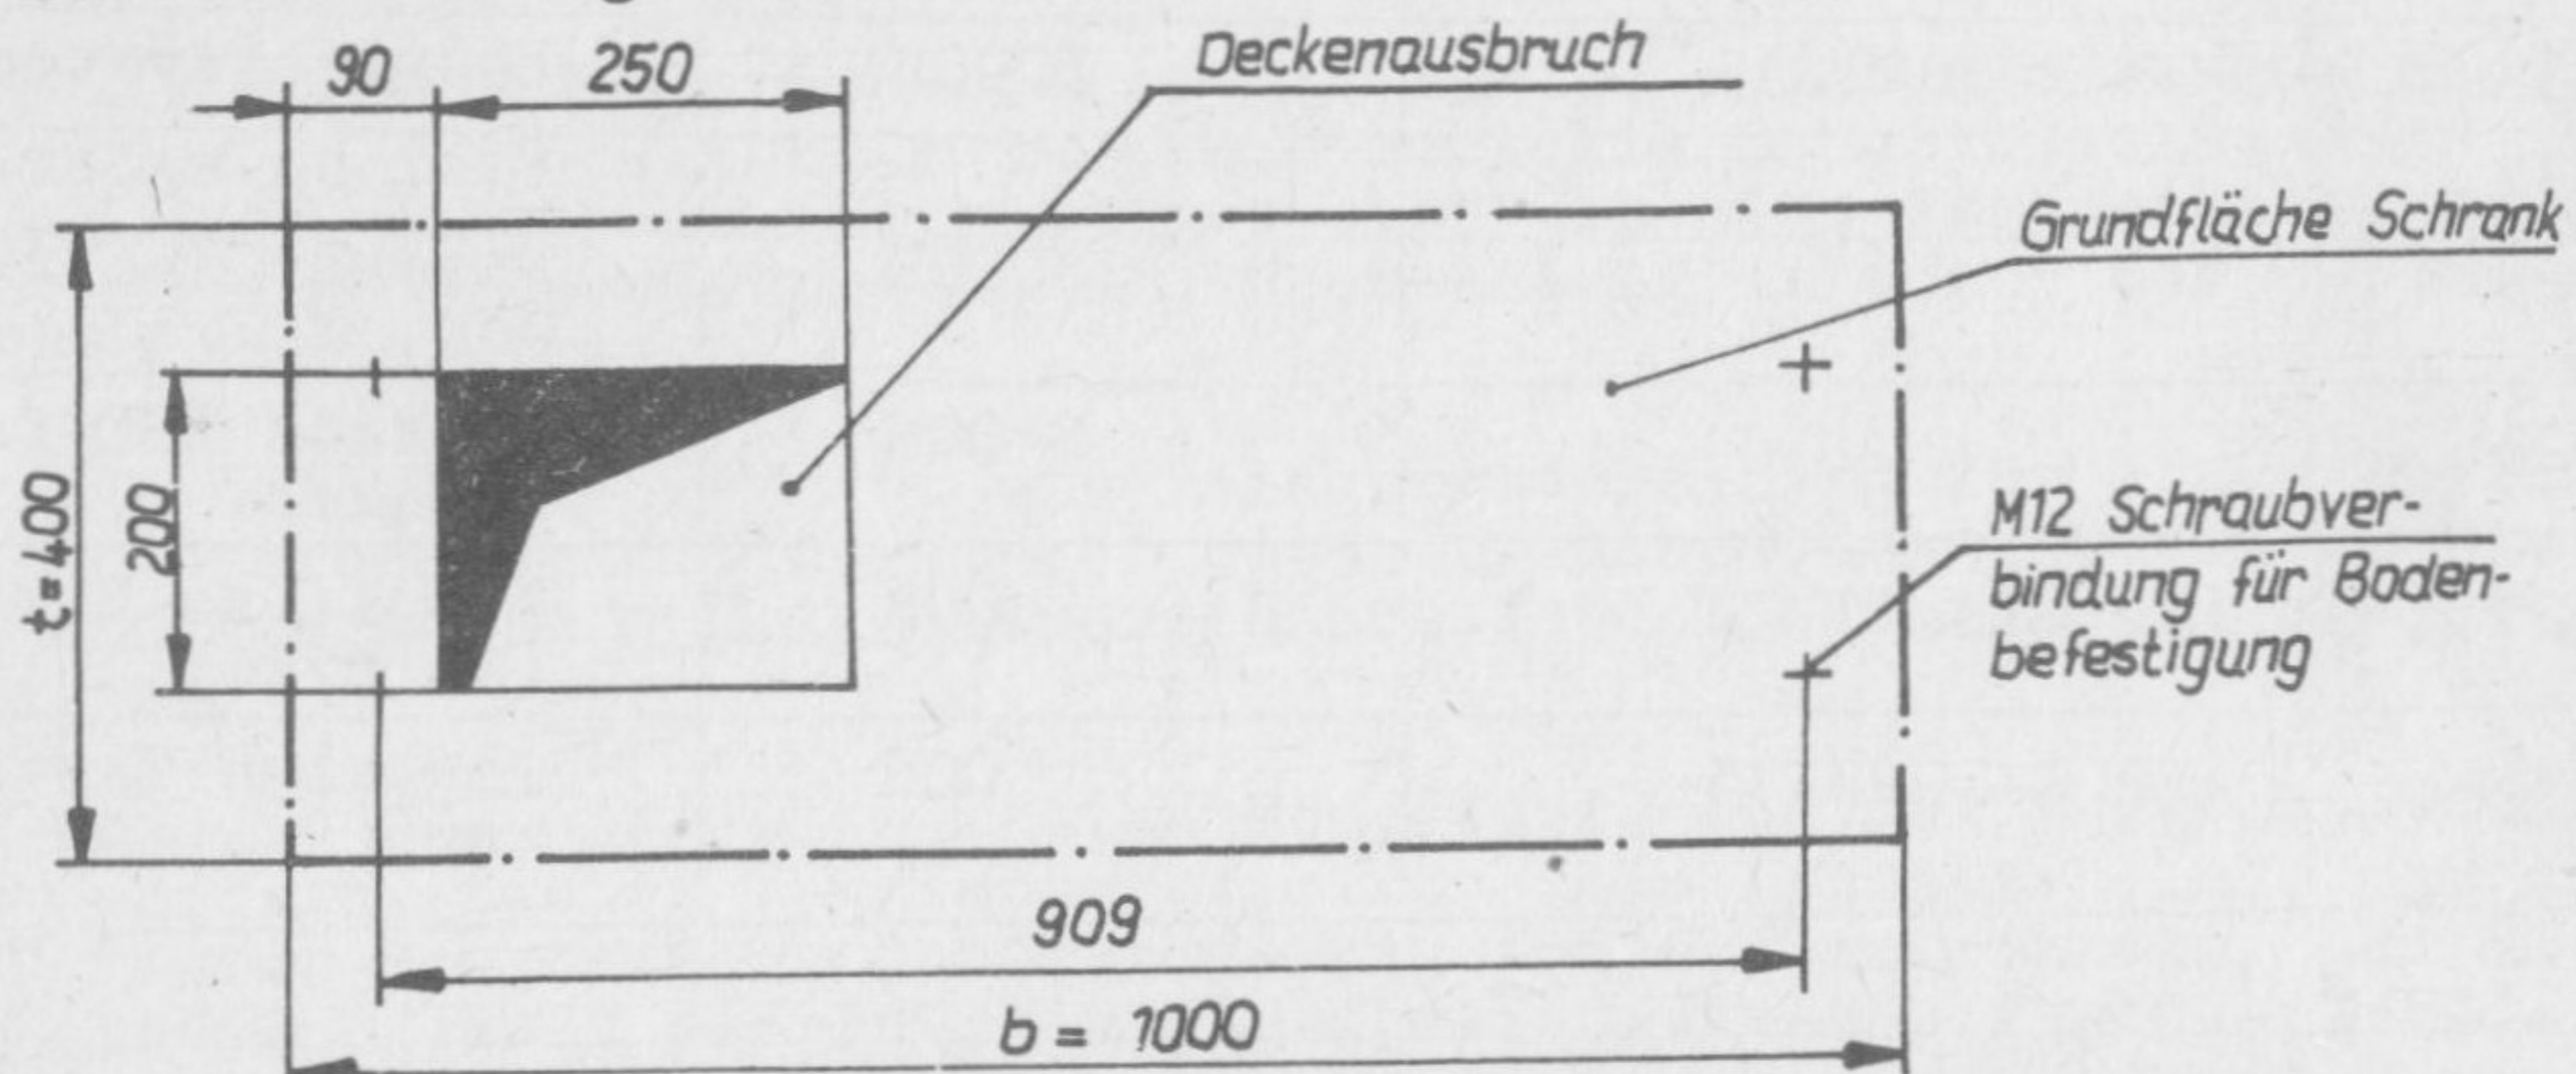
Fundamentbefestigung und Deckendurchbruch
